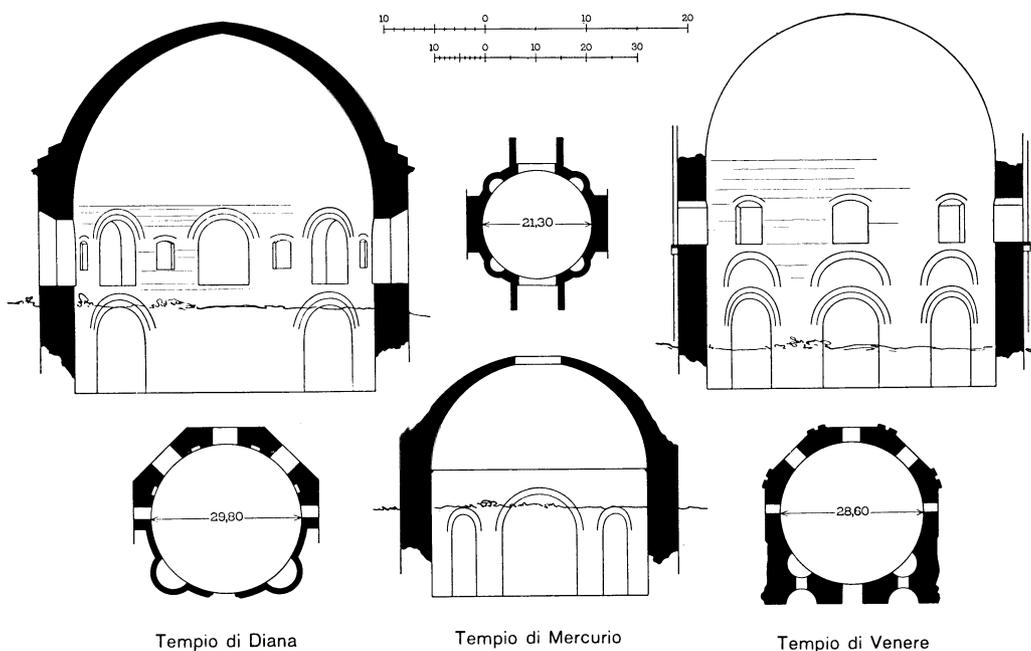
368. Kuppeln der Thermen in Bajä. Schnitte 1:750. Grundrisse 1:1500.
